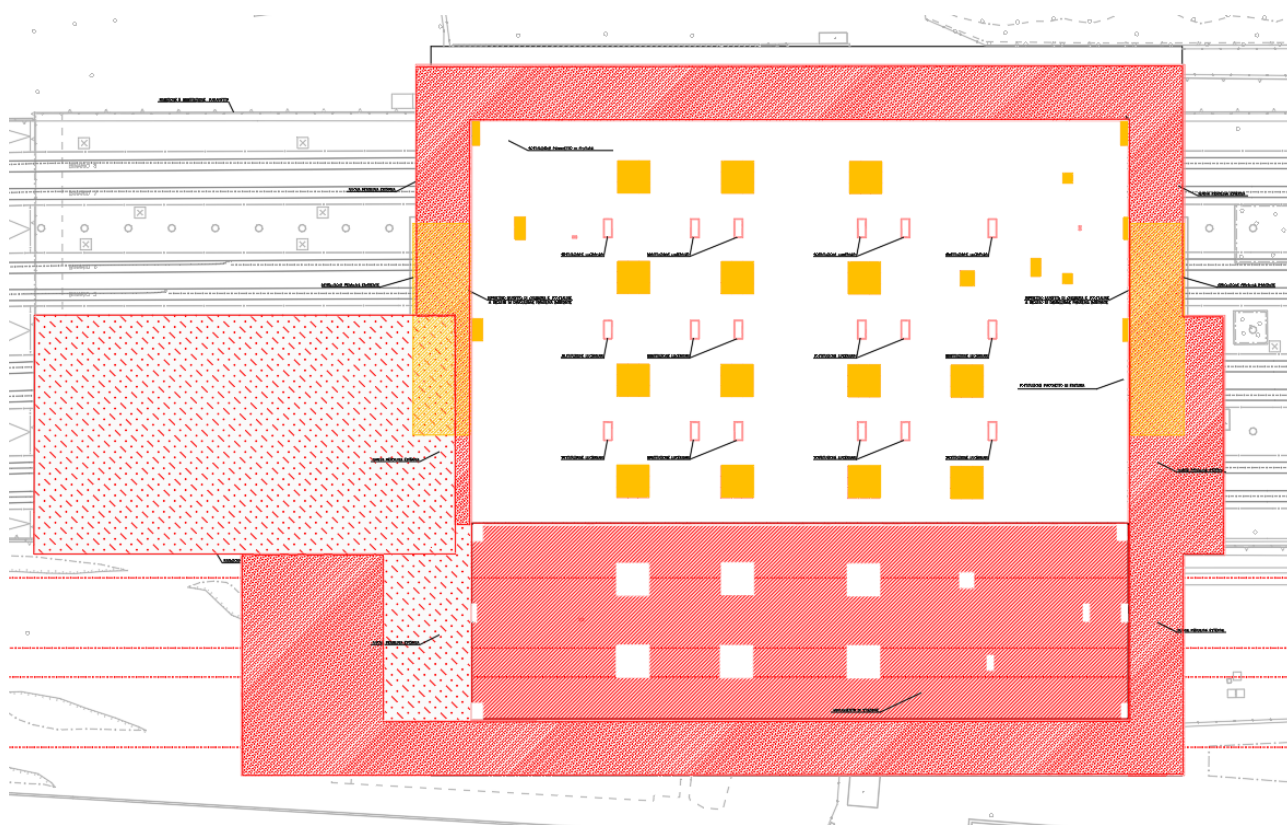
Planimetria demolizioni Piano Coperture Stazione di Bovisa (demolizioni in giallo)
